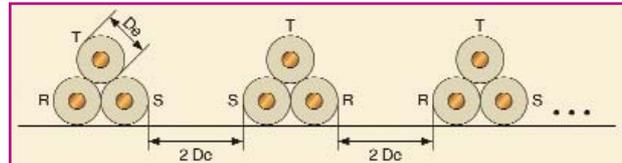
Disposição com os cabos de cada grupo RST posicionados em trifólio
